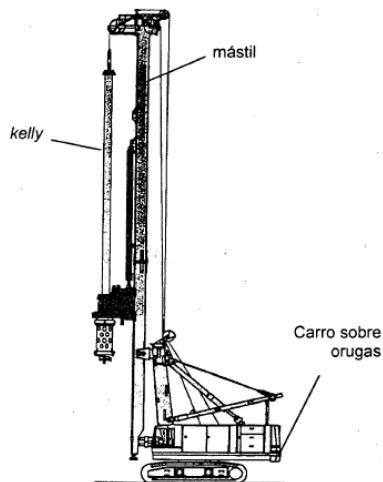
y 29 .Equipos de perforación de rotación de barretón tipo Kelly. Pilas en Tobas
